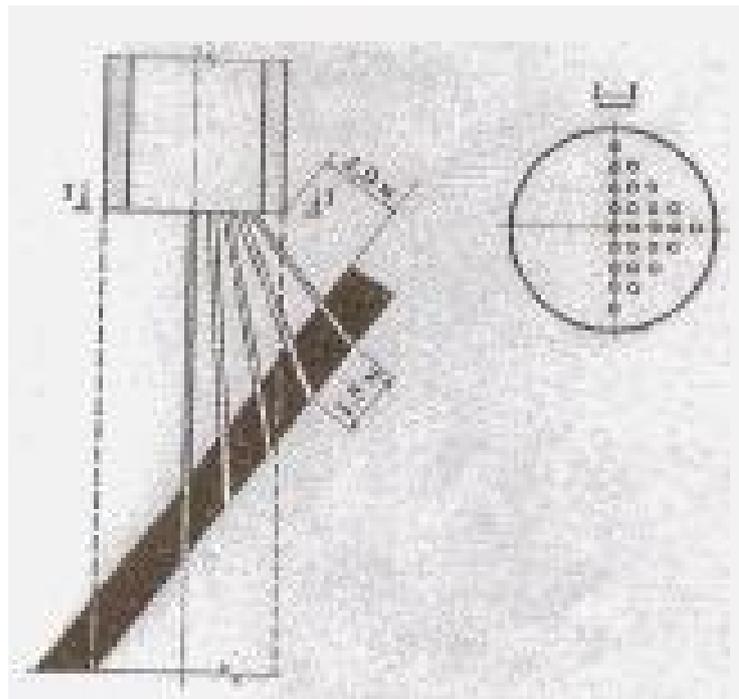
Схема расположения дренажных скважин при вскрытии стволами крутых и крутонаклонных пластов
